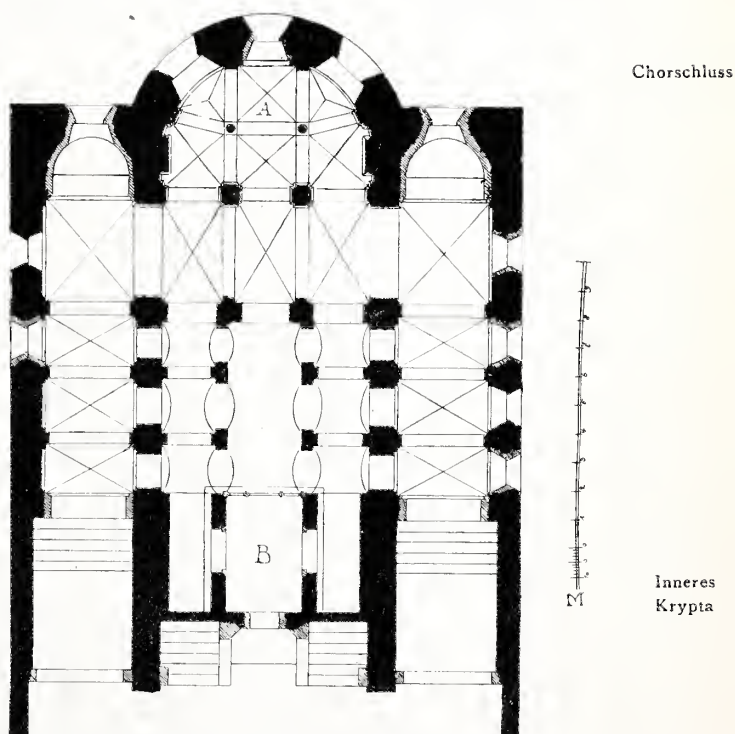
Münster Eifel. Stiftskirche. Grundriss der Krypta.
